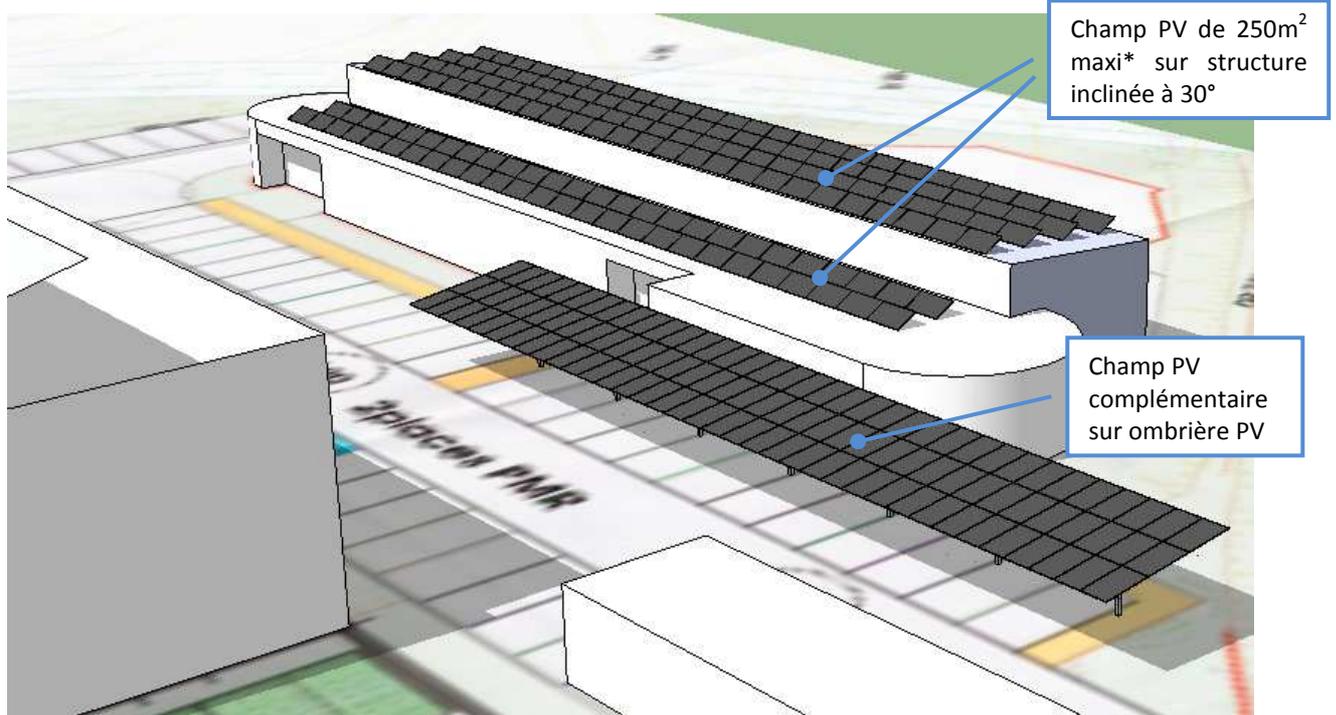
Croquis d'implantation du champ PV sur l'atelier et en ombrière de parking
